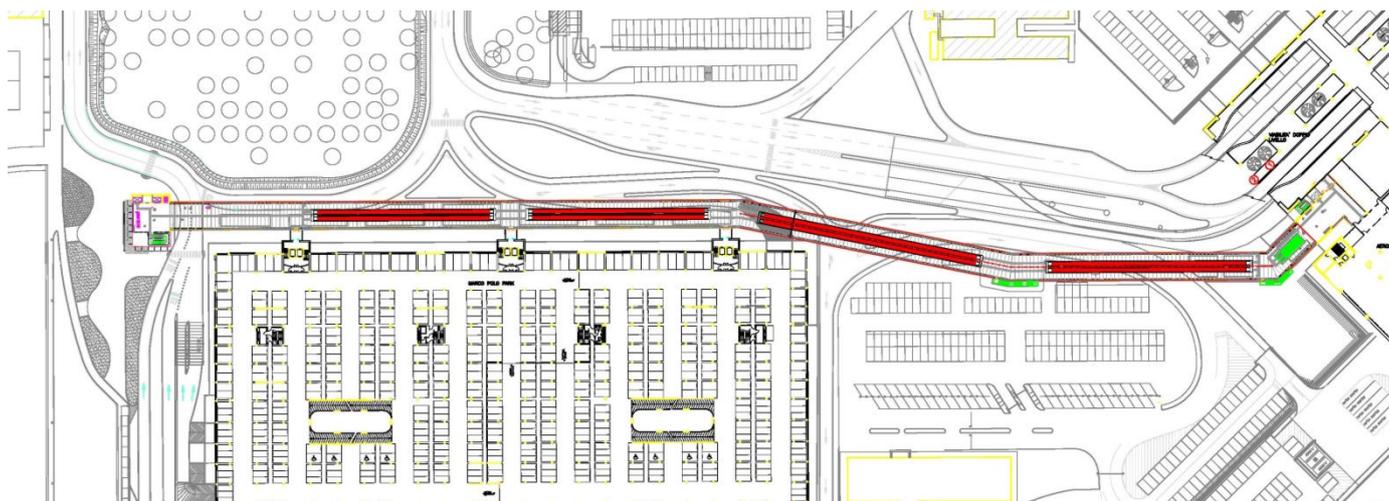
Percorso pedonale assistito Moving Walkway - Planimetria di progetto
